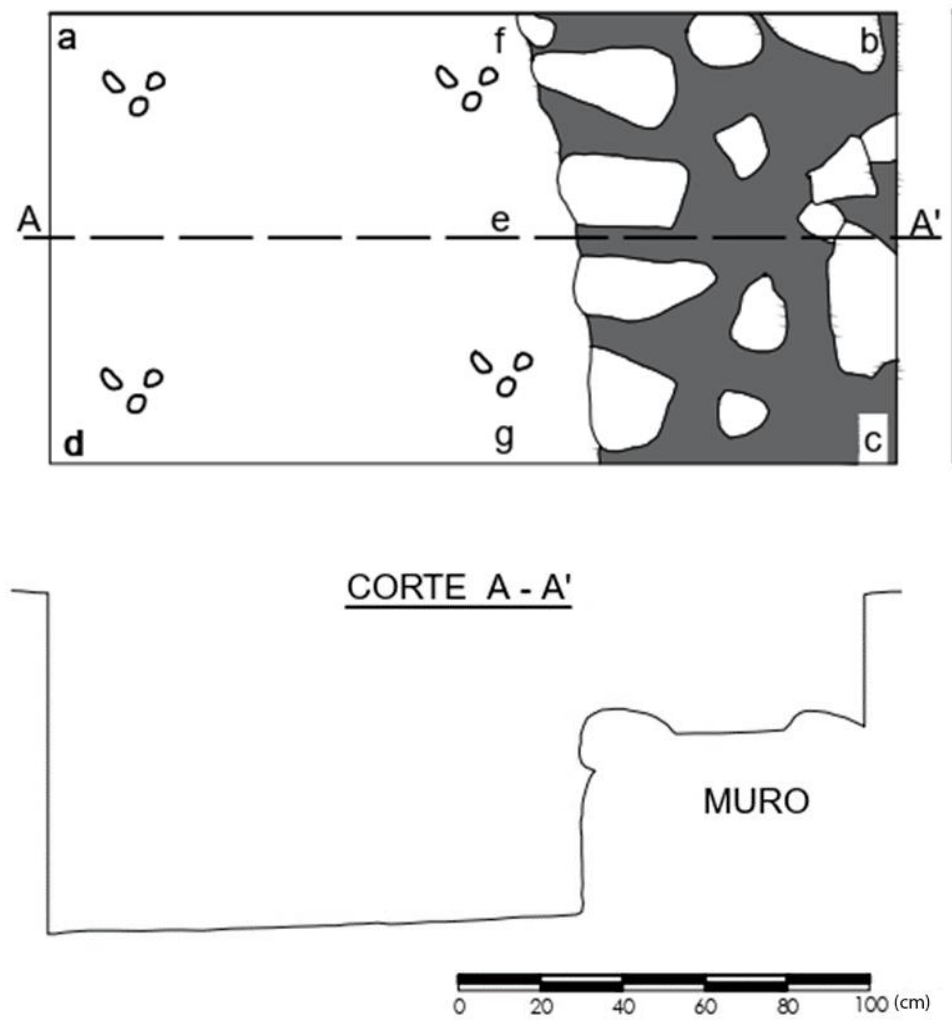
Dibujo del paramento del muro 05, dibujo de planta y corte A-A'.
